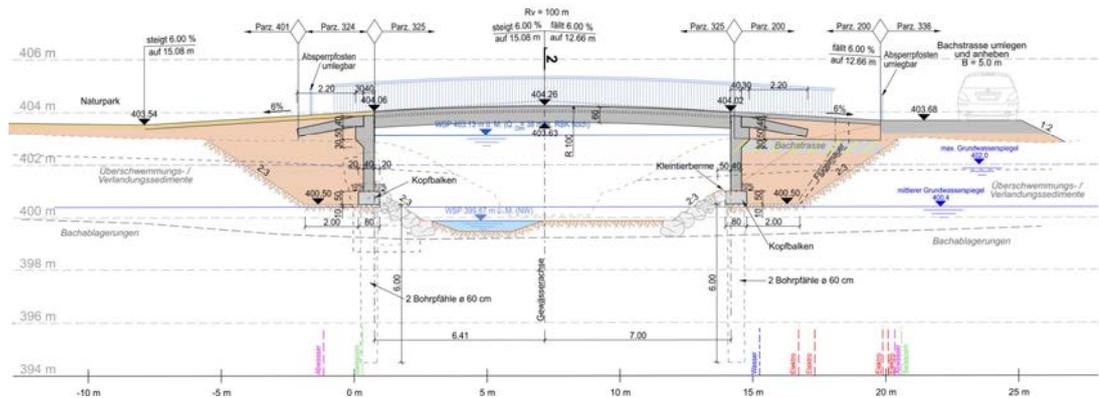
Vertikale Linienführung des Haslachstegs, Littenbach
